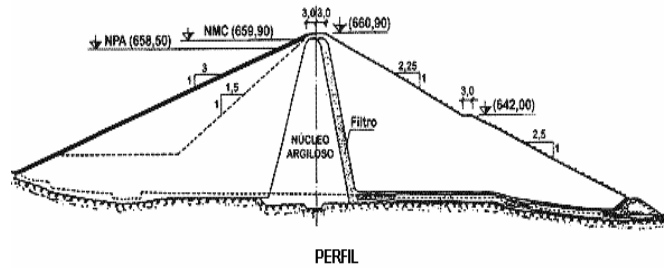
Barragem de terra zonada com tapete drenante e dreno chaminé inclinado do Alijó (CNPGB).
